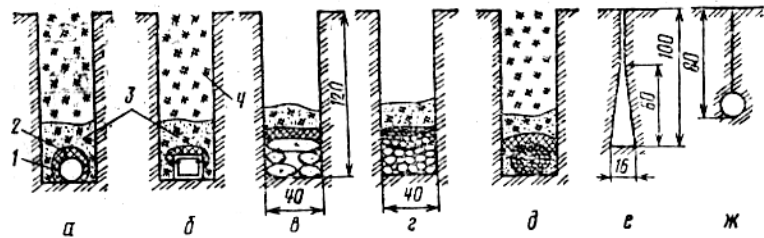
Конструкция закрытых дренажей (в разрезе): а – дрена из гончарных или пластмассовых труб; б – деревянная дощатая; в – из каменных плит; г – каменной наброски; д – фашинная; е – щелевая; ж – кротовая; 1 – труба; 2 – защитно-фильтрующий материал; 3 – гумусированный грунт; 4 – смешанный грунт. Размеры указаны в сантиметрах
